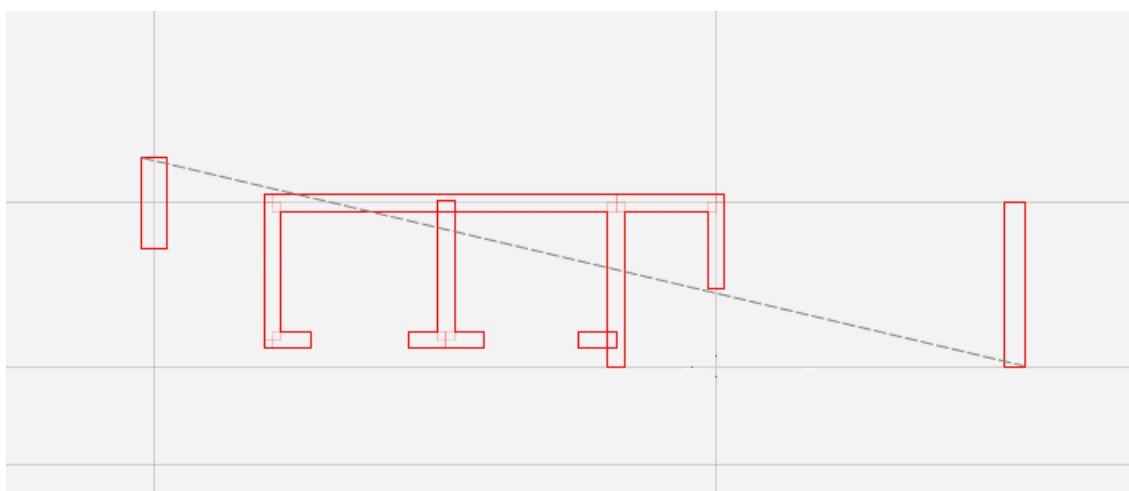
Minh họa cho việc xác định vị trí đặt tâm đài móng
